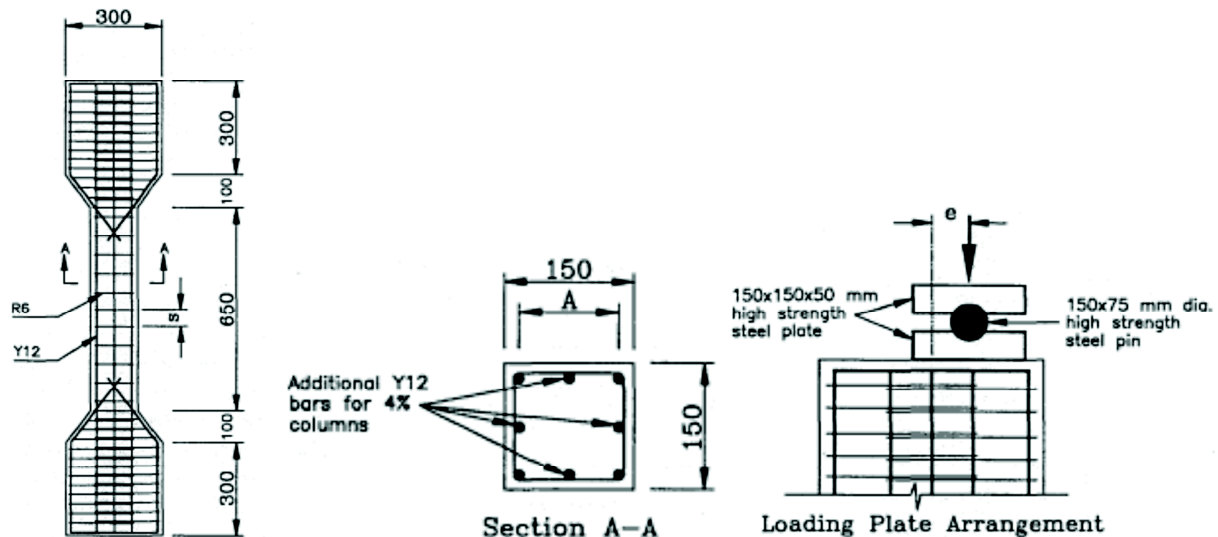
Bewehrungsplan und Versuchsaufbau [2]
